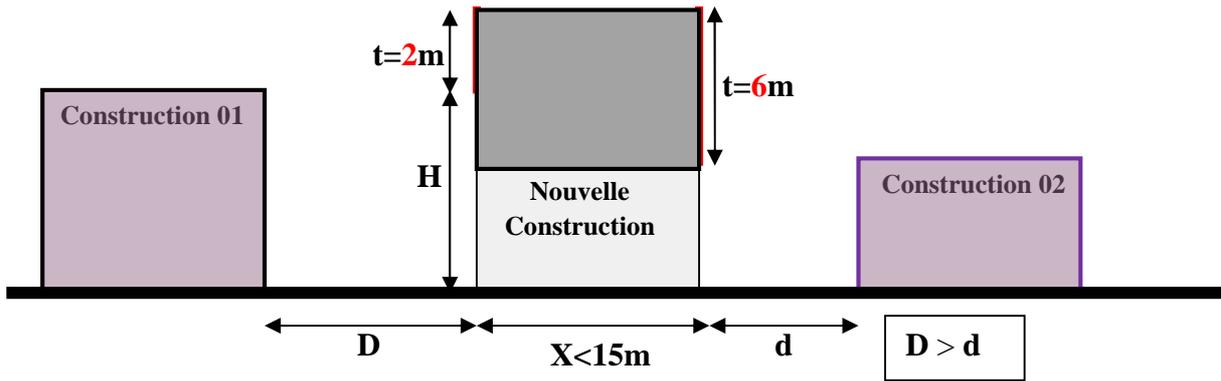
Coupe définissant la hauteur d'une construction localisée entre 02 voies d'inégales largeurs (voies au même niveau)
